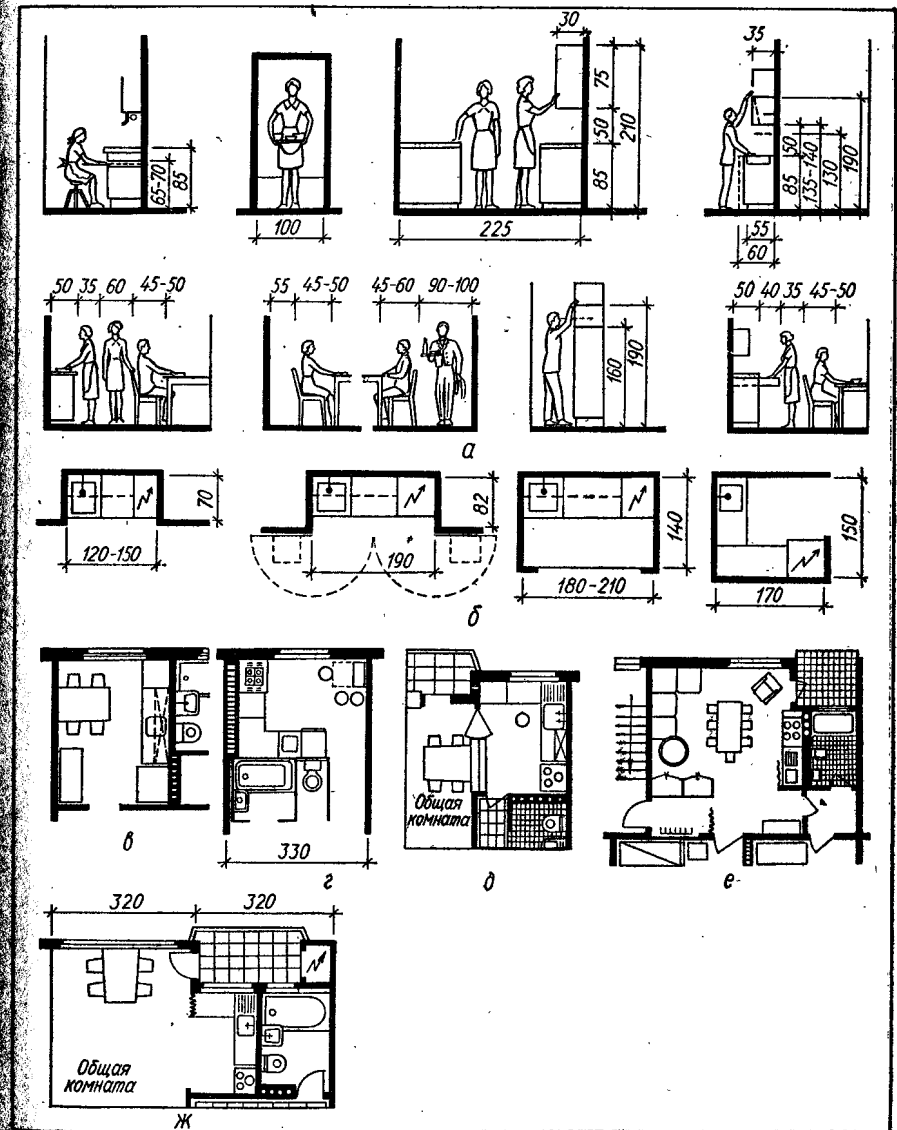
Габариты и оборудование кухни — исходные данные для проектирования; б — планировка кухни-ниши с электроплитой; в—д — схемы планировки кухни с газовыми плитами; е, ж — схемы планировки квартир с кухнями-нишами на газовых плитах.
